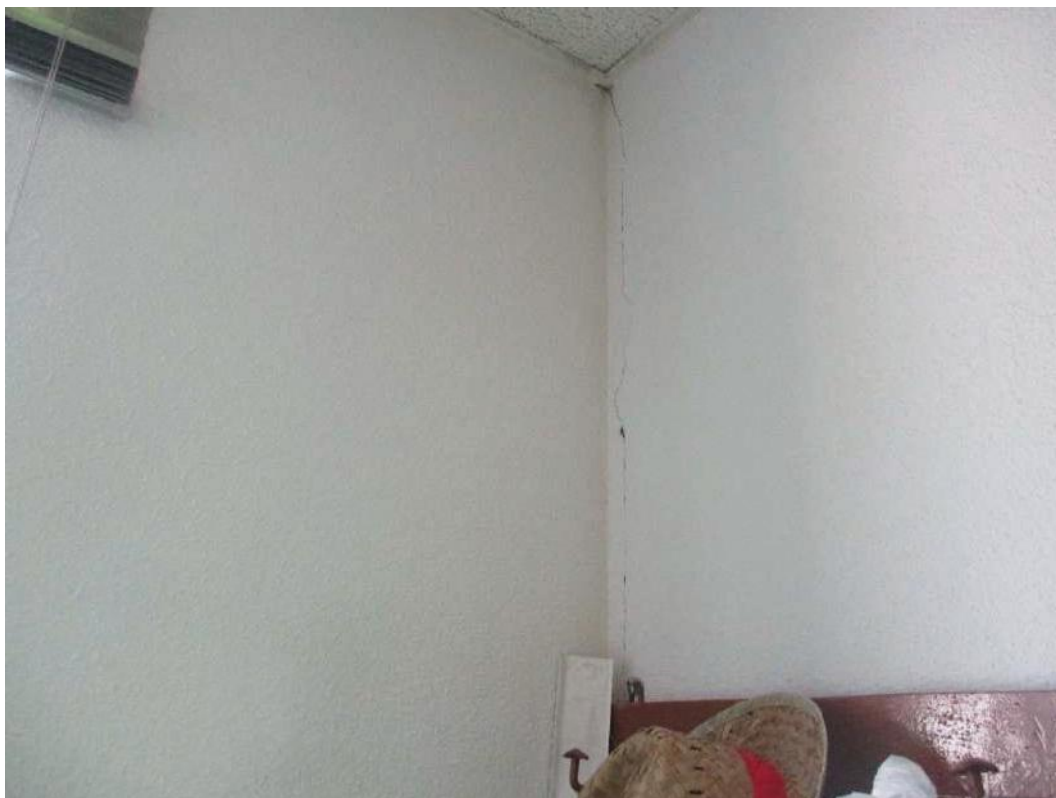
fisura inclinada en la hoja interior del cerramiento de fachada, con signos de reparación previa.
